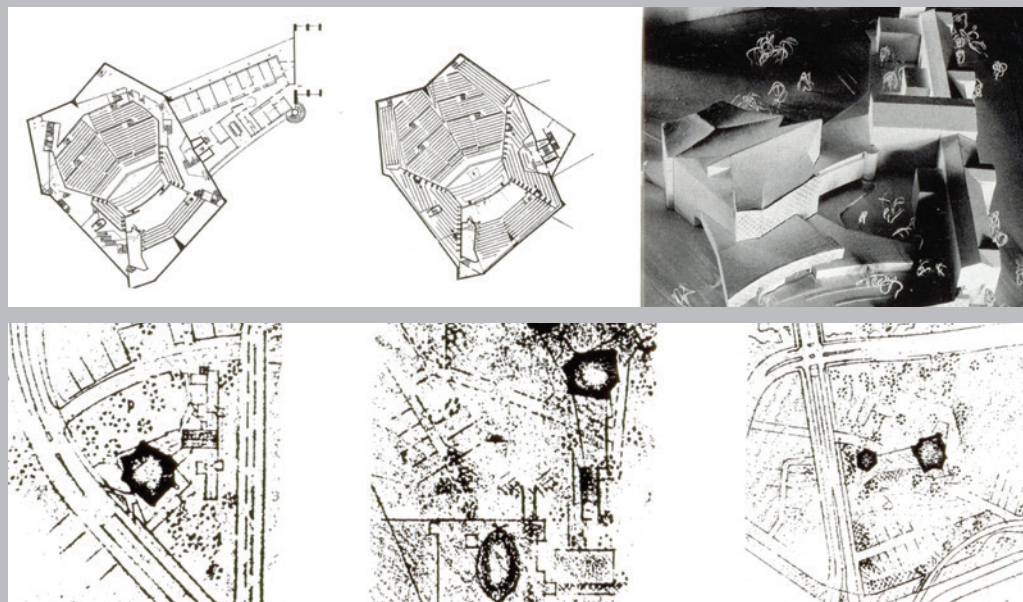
(Arriba) Plantas y maqueta de la primera ubicación de la Filarmónica de Berlín (1956).
